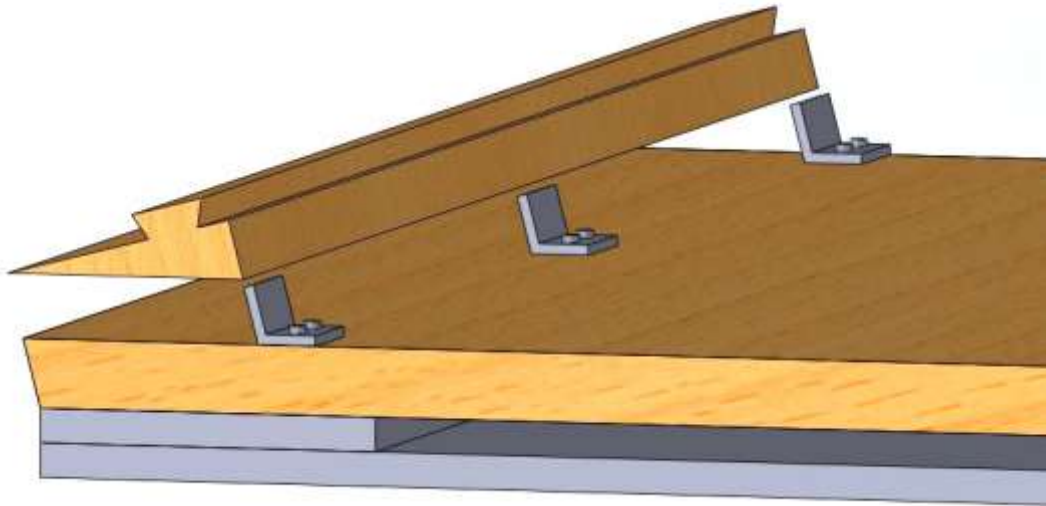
Ensamblaje del cierre macho con el soporte y las esquinas
